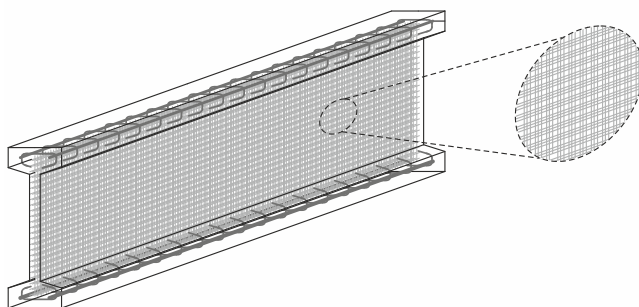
Betonträger mit dünnwandigem, mikrobewehrtem Steg
